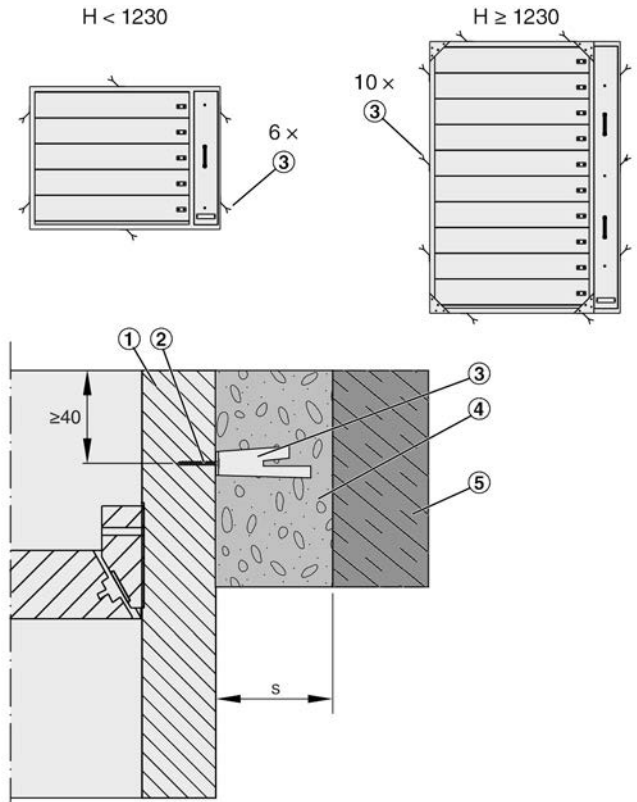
Installazione a base di malta della EK-JZ con linguetta di fissaggio
